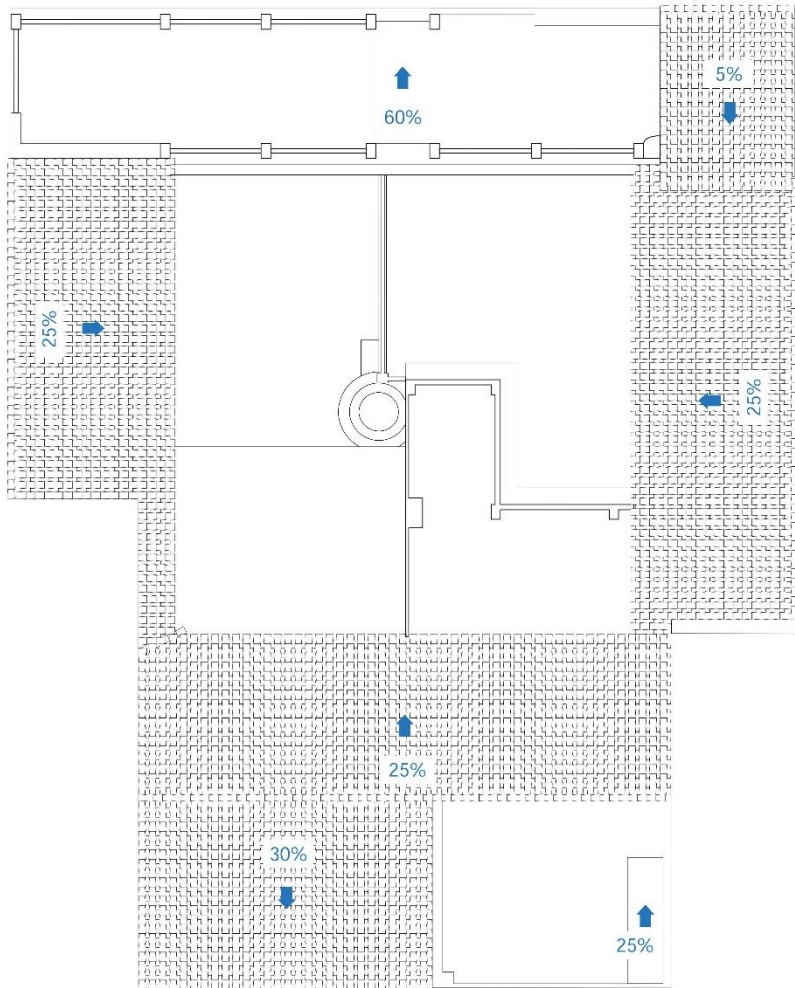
Planta de cubiertas (Alejandro Serra 2016).
